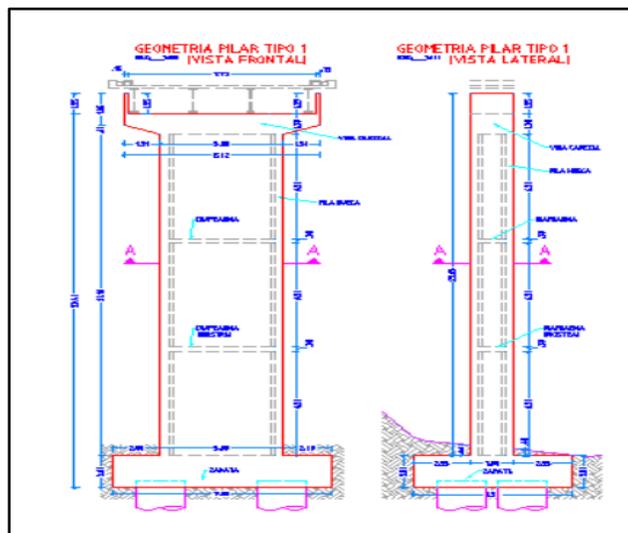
Diseño de pilares centrales vista frontal y de perfil de la pila 1
